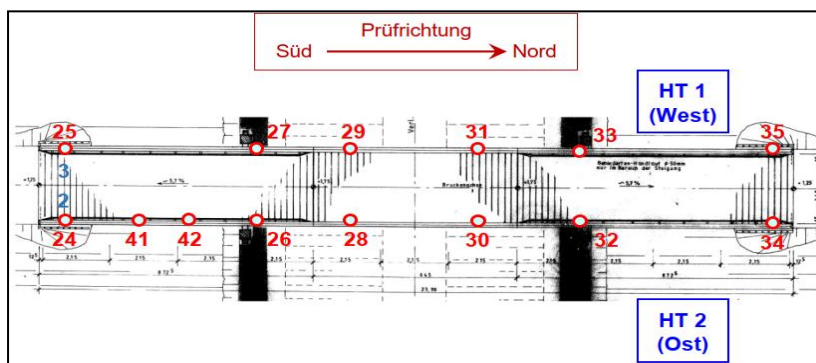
Draufsicht mit Lage der Bohrungen (rot) und Feuchtemessung (blau)
